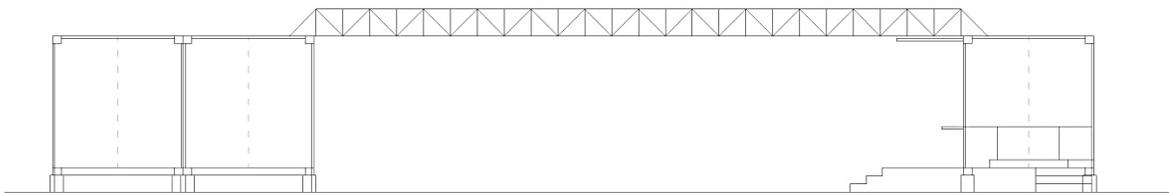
Alzado restaurante y sala de juntas, Núcleo 2
